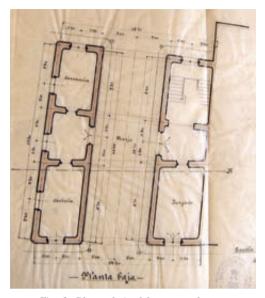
Planta baja del proyecto de casa consistorial de Cosuenda, 1921 (A.D.P.Z.).
